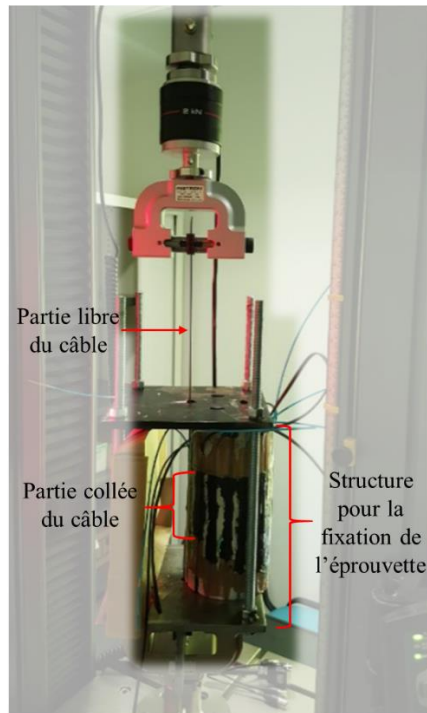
Essai d'arrachement d'un câble collé en surface d'un cylindre de béton.
